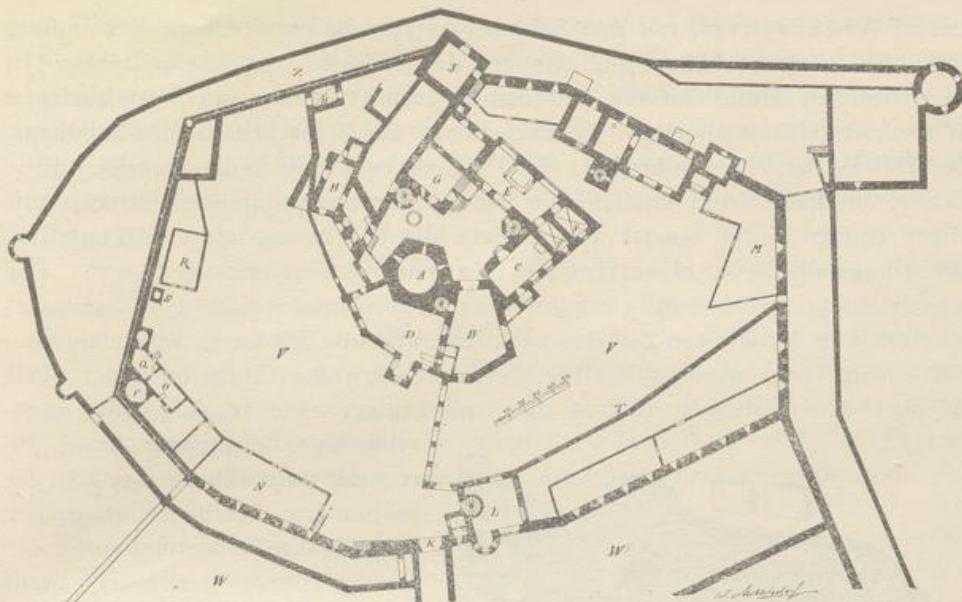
Grundriss des Schlosses um 1600.
